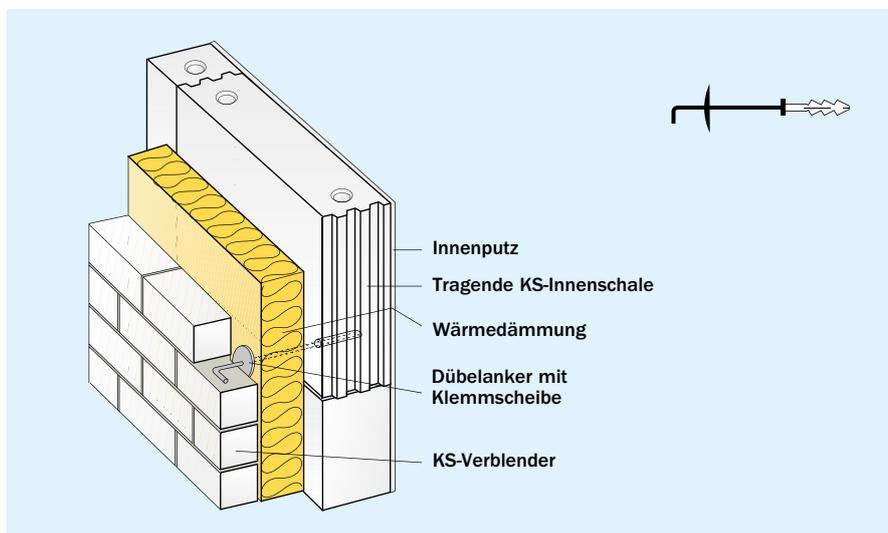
Systemaufbau zweischaliges Mauerwerk mit Wärmedämmung
